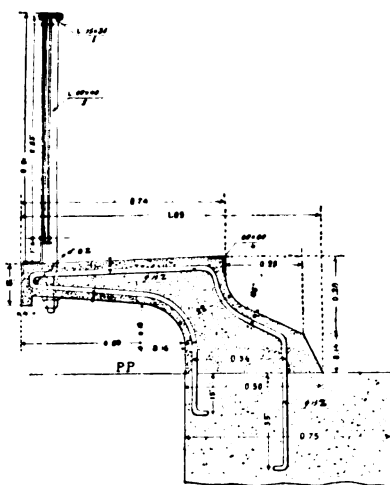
Dettaglio mensola a sbalzo in cemento armato.
